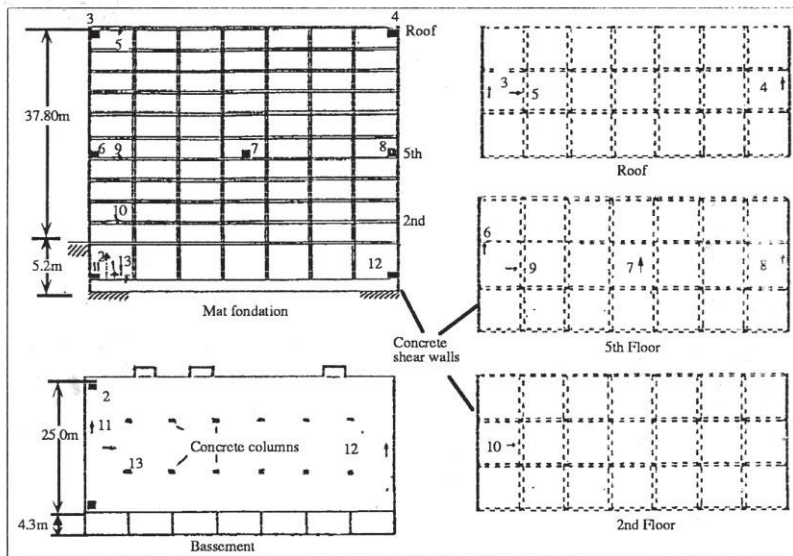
Vues en plan et coupe N - S du bâtiment "exemple".
